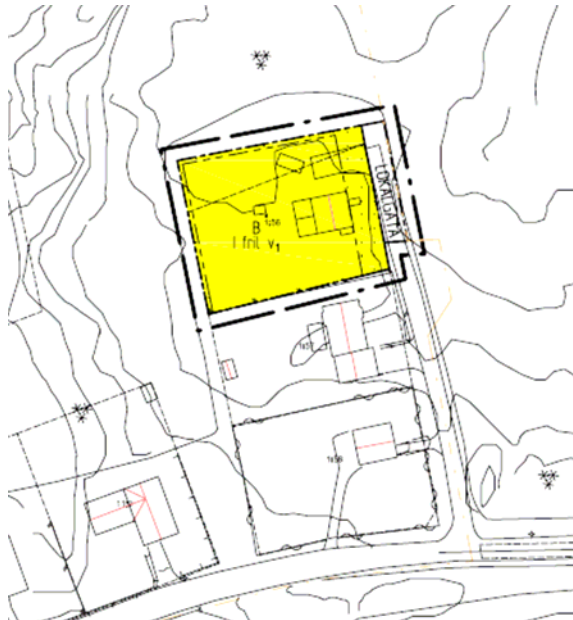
Bilderna är utdrag ur idag gällande detaljplan fastställd av Länsstyrelsen 1963-02-03.
